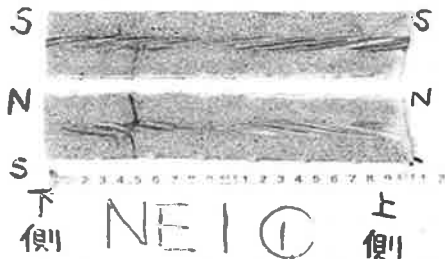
ひび割れ状況（PC 鋼より線 ①）
